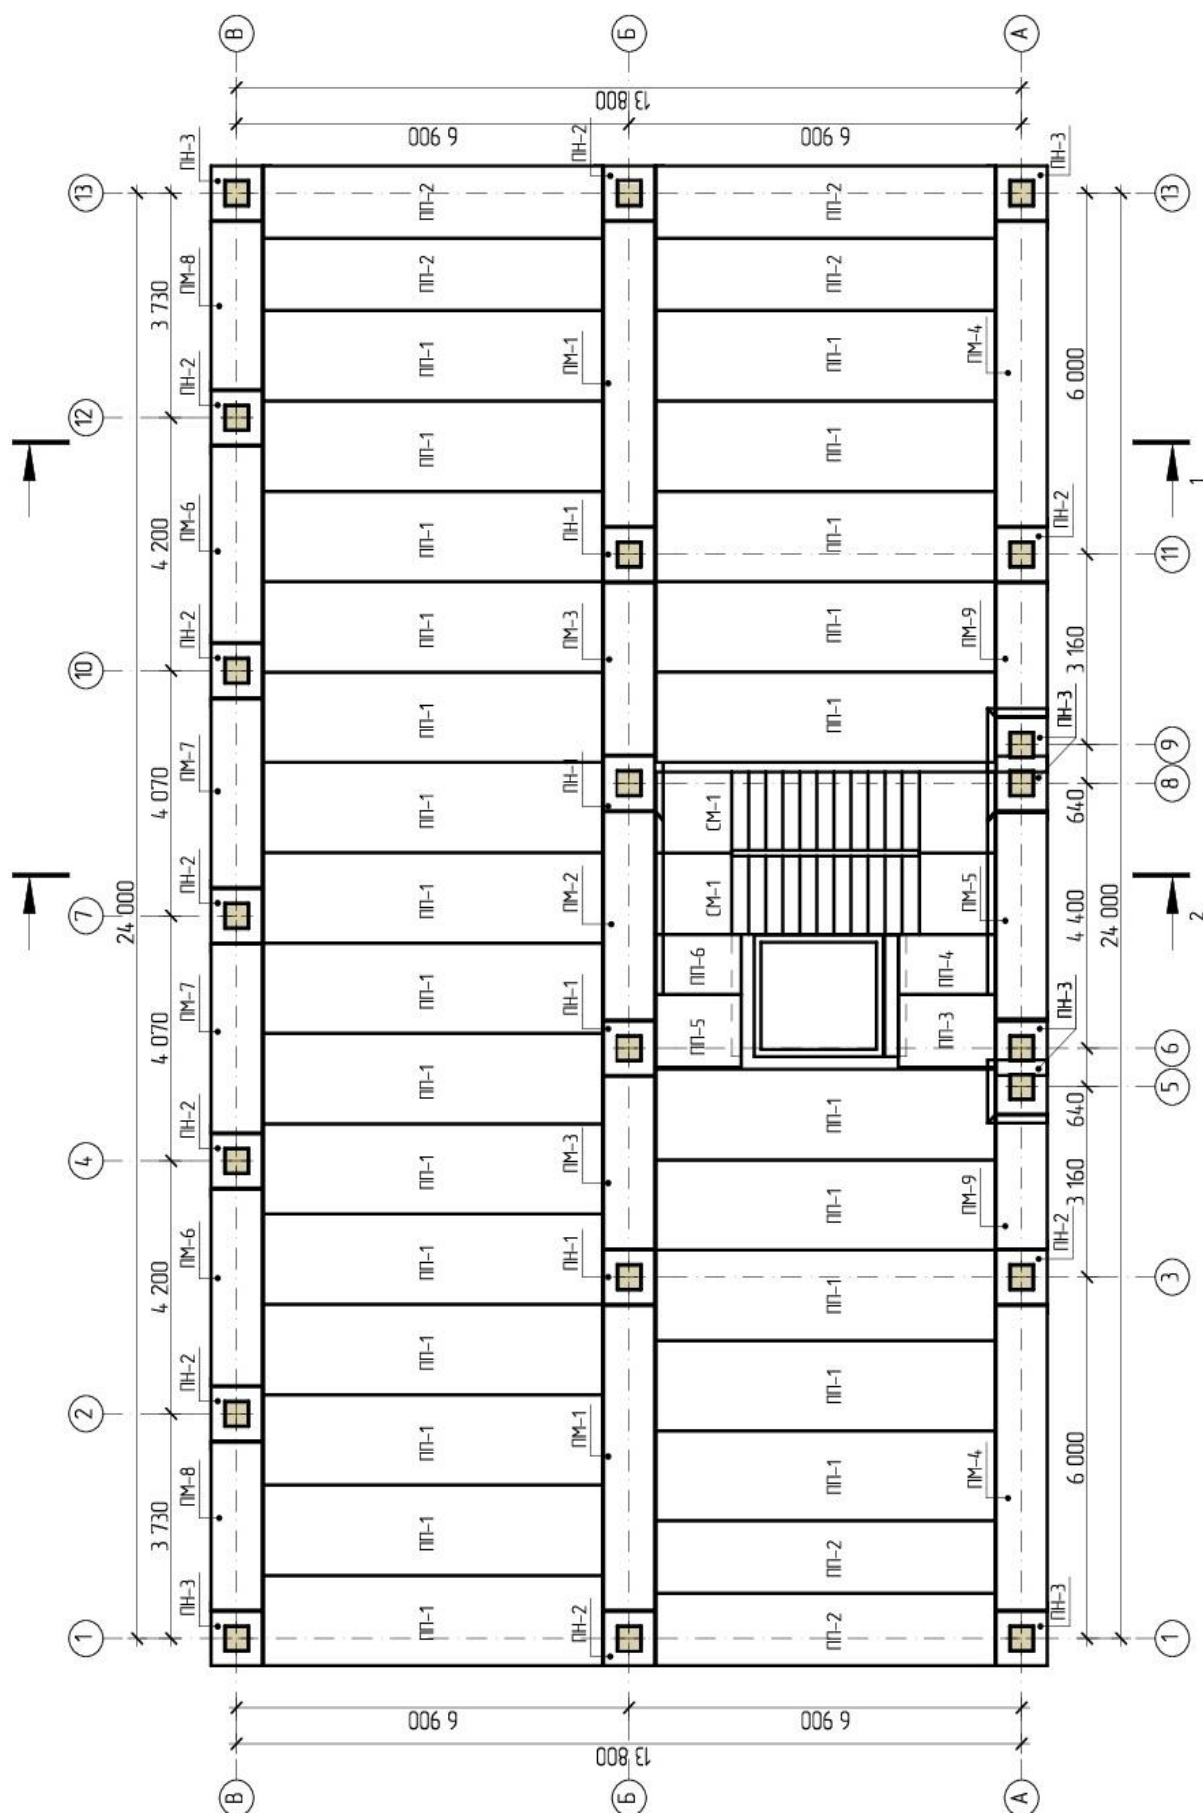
Розкладка плит запропонованого варіанту безбалкового перекриття
